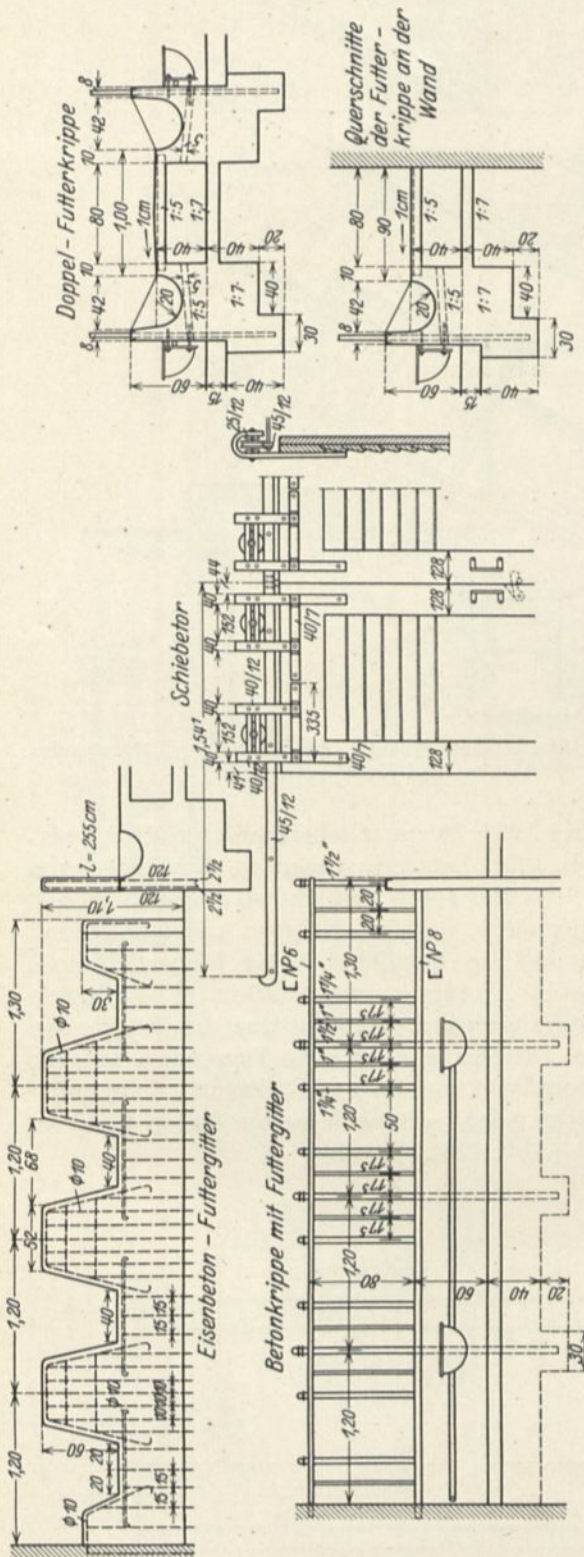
Stallgebäude Kehidai. Einzelheiten der Eisenbetonkrippen und Schiebetore.
